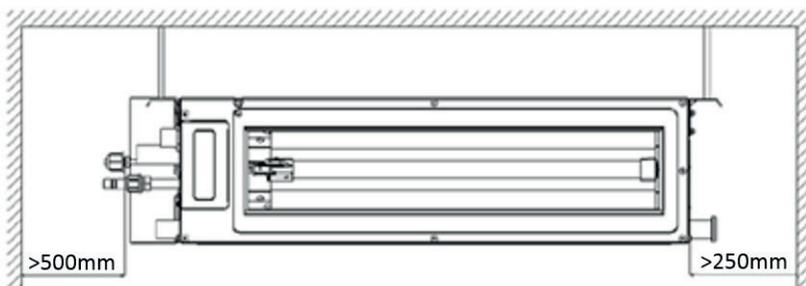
Dimensiones de instalación Fan & Coil
